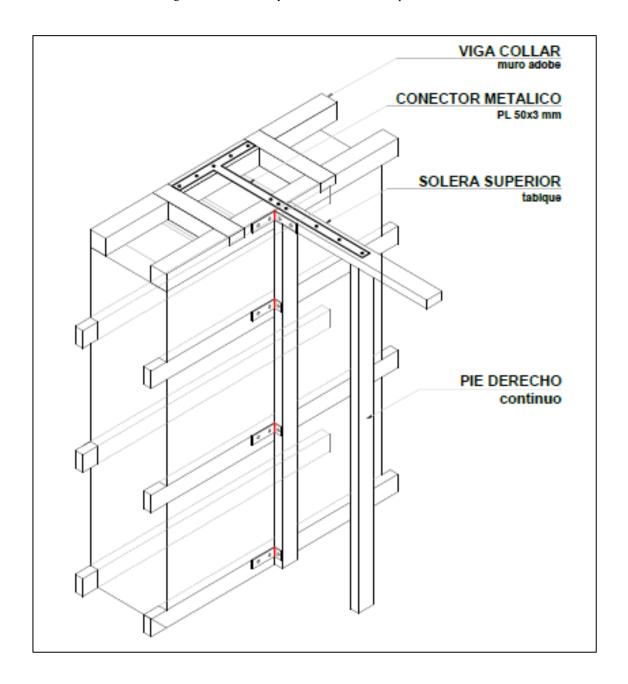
Escantillón tipo, proceso de reparación de vivienda adobe Zúñiga.
